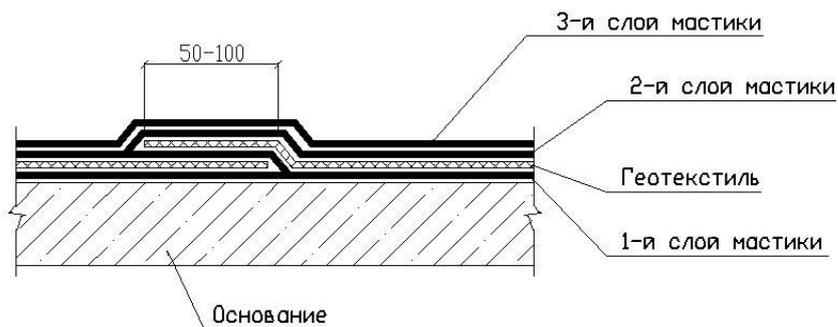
б. Укладка полотен геотекстиля с перехлестом.
